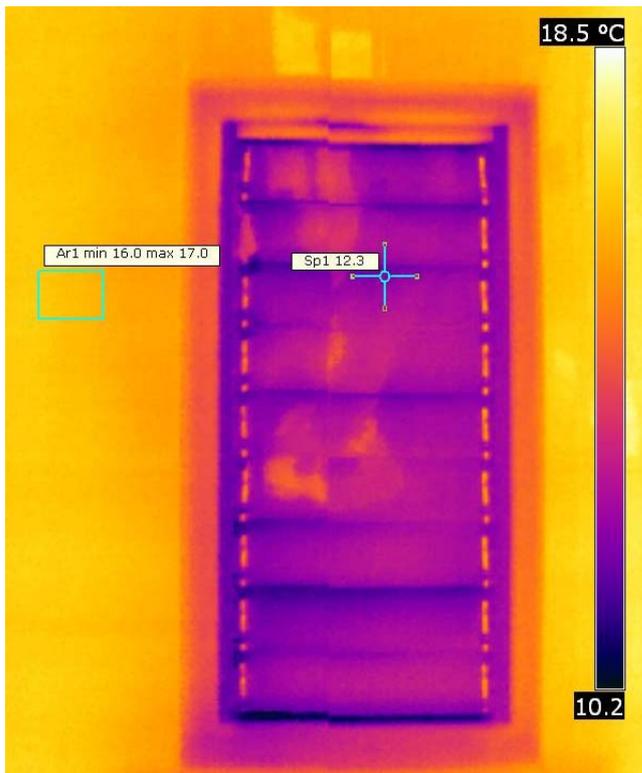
Interior dormitorio. Fachada Oeste y Norte.
